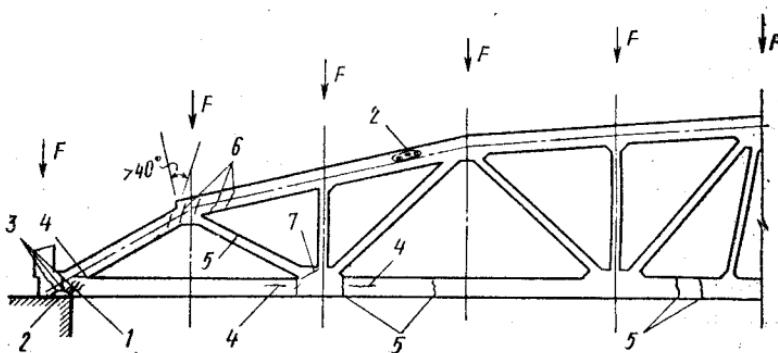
Характерные повреждения силового происхождения в железобетонных фермах с нижним предварительно напряженным поясом:
